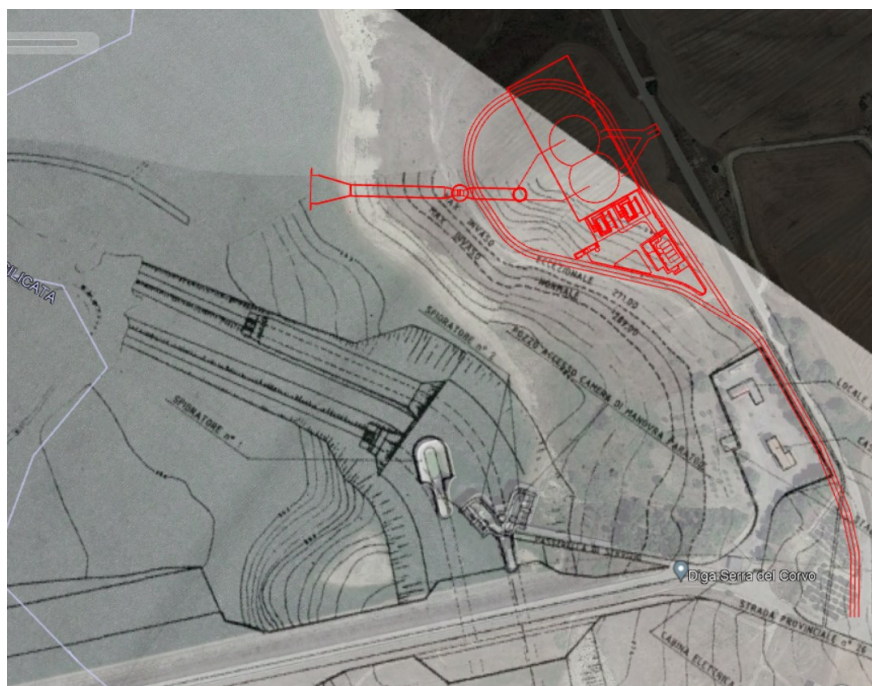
Layout originale della diga di Serra del Corvo, con rappresentazione di una porzione della batimetria del sopraccitato documento “Planimetria generale delle opere esistenti”
